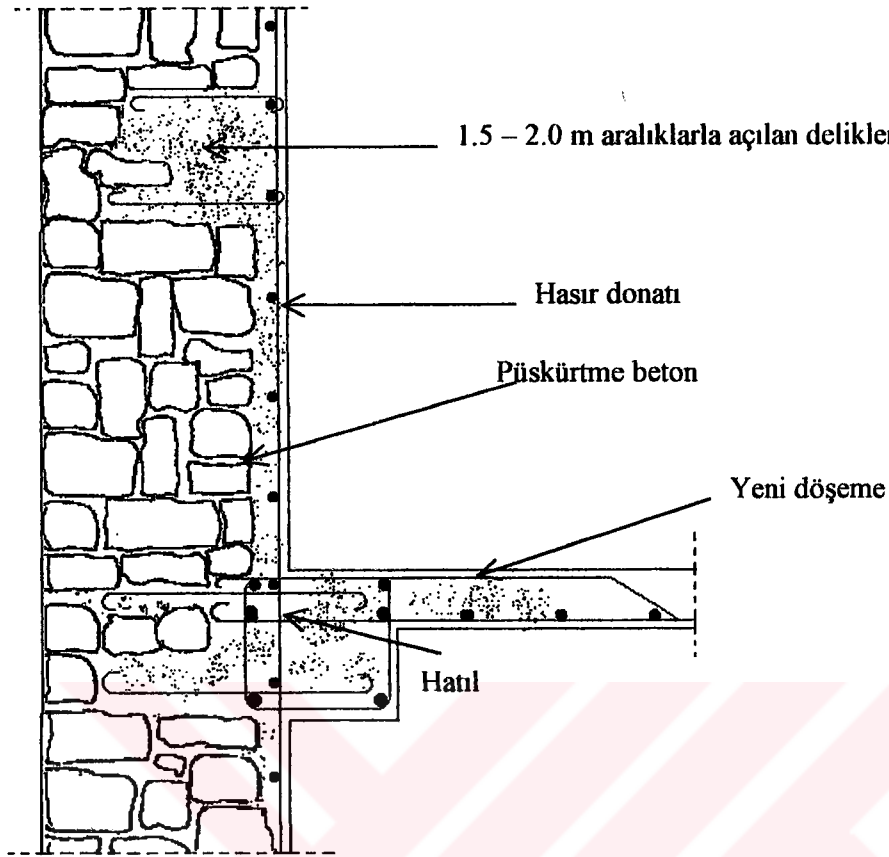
Betonarme mantolama ile ilgili detaylar
